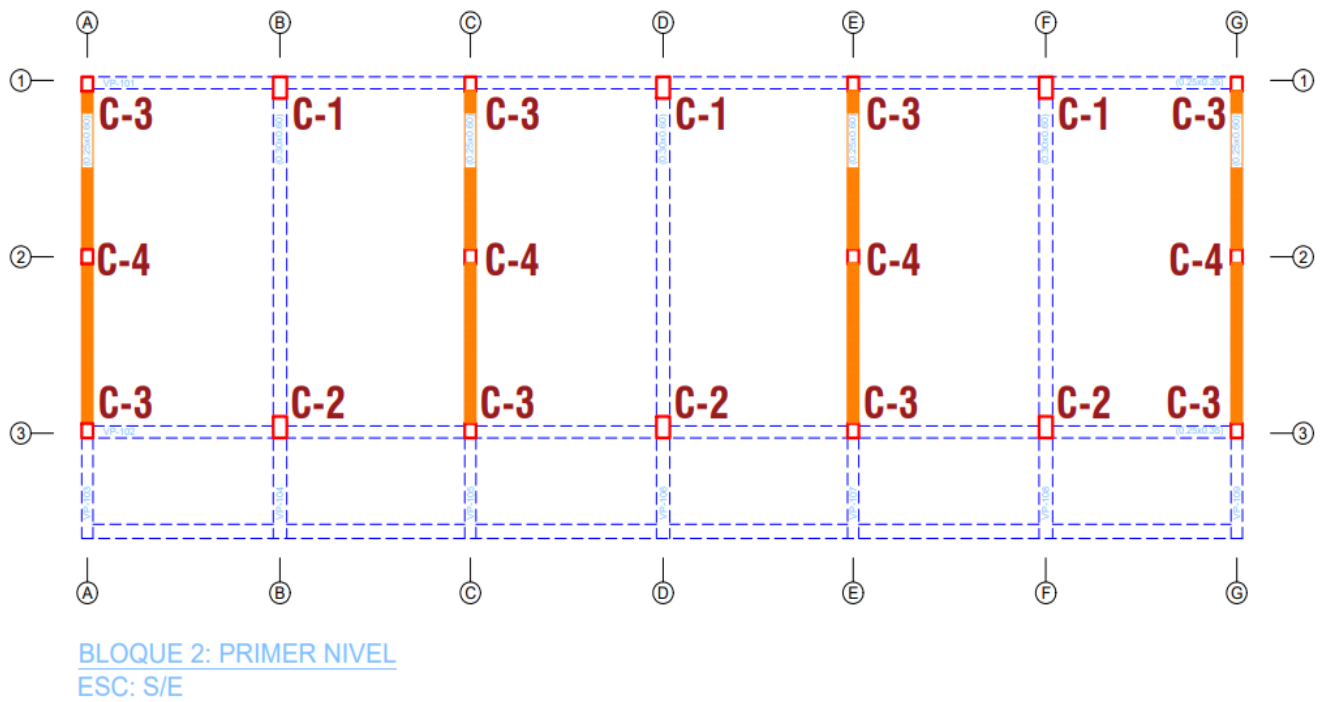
Arranque de acero exterior en columna de pórtico Bloque 2
